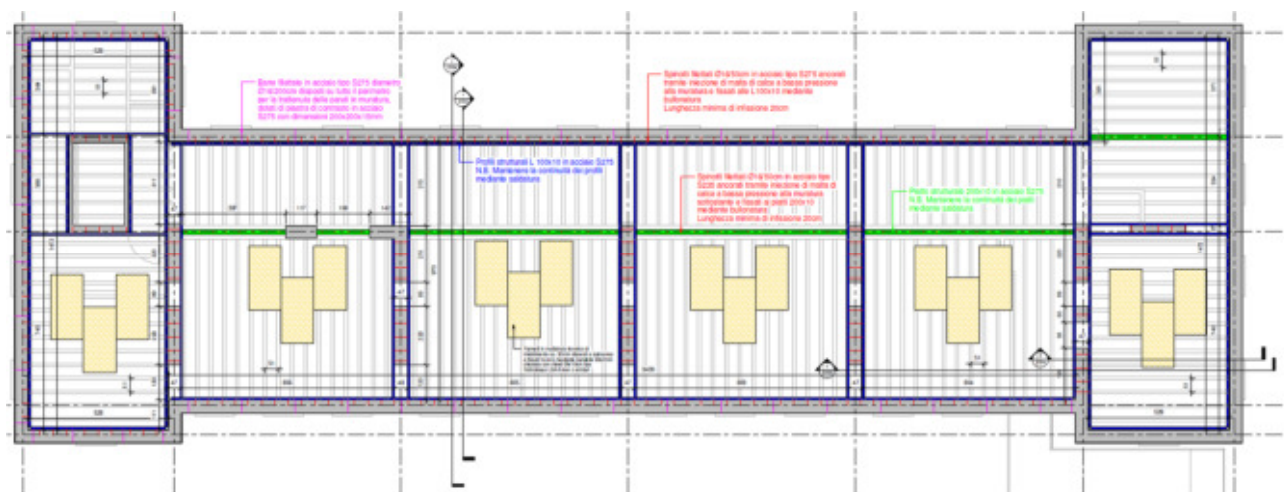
Pianta del sottotetto con indicazione dell'intervento
